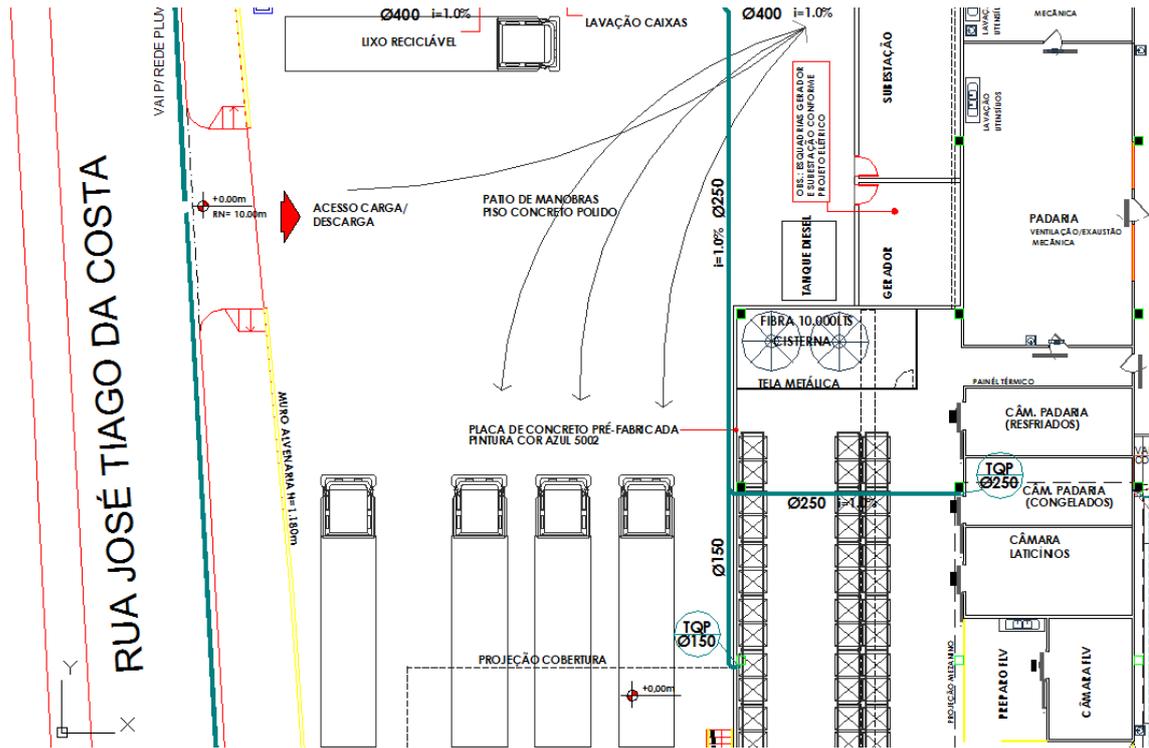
Docas de entradas de Caminhões e veículos de clientes pela Rua José Tiago da Costa– Vista em planta, sem escala.
